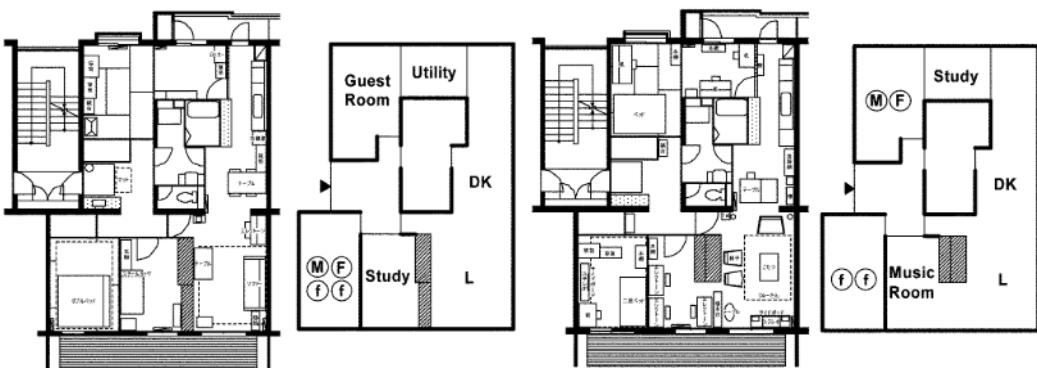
Planta baixa tipo A construção KEP, demonstração de uso da divisória.
